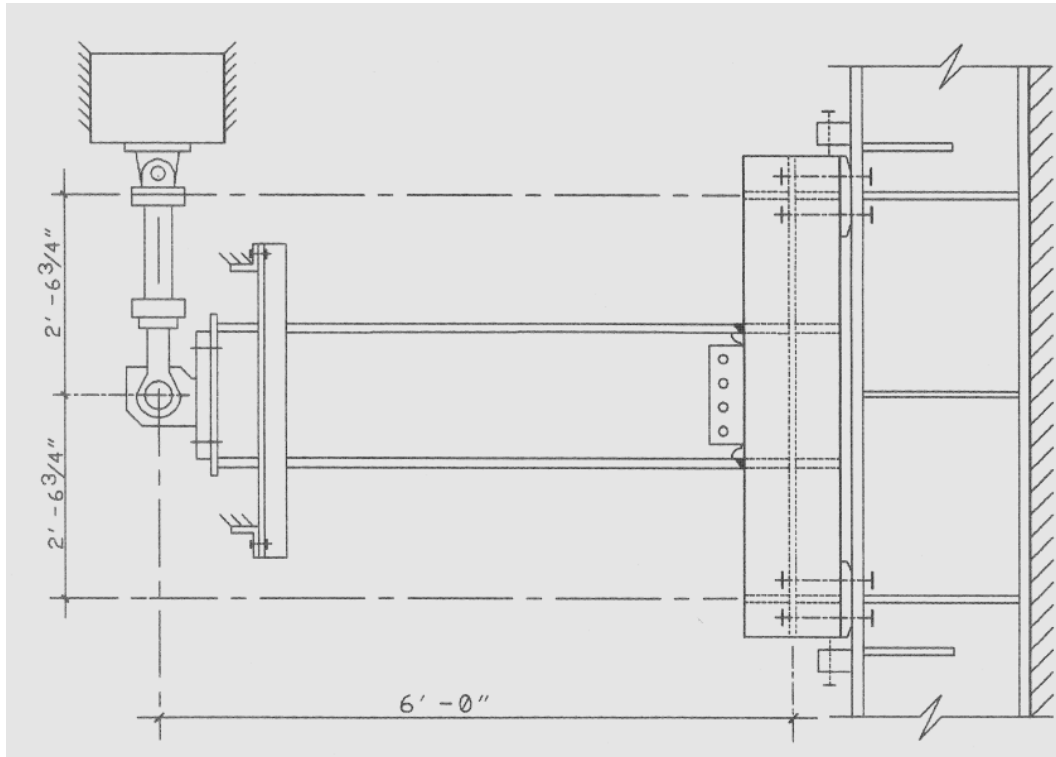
Pilot çalışmaların test düzeneği. (Driscoll ve Chen, 1979)
